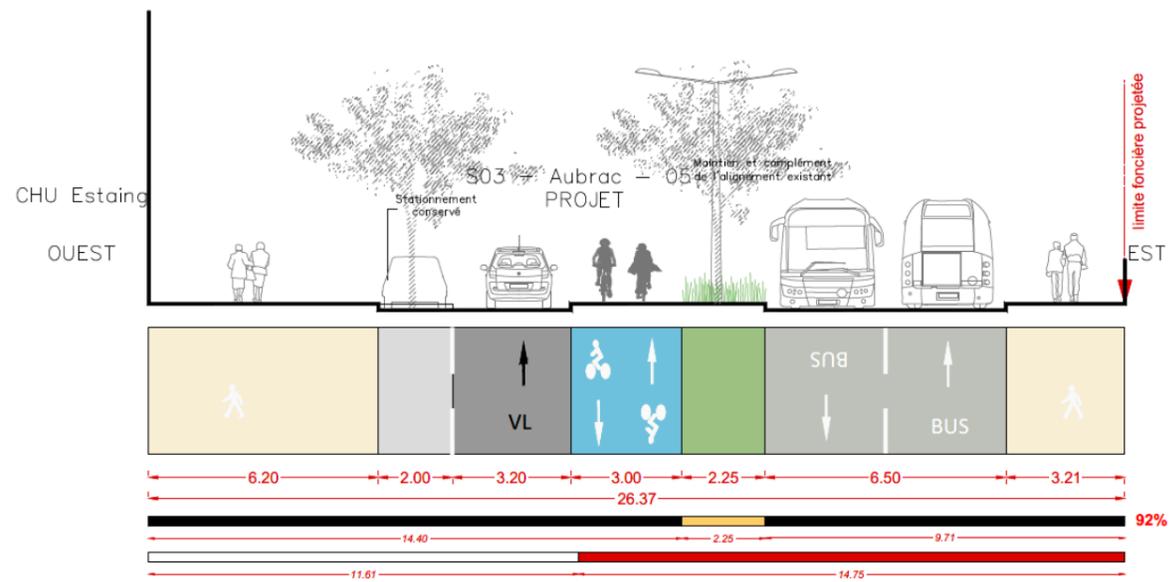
Profil d'insertion du projet de BHNS sur la rue Aubrac au droit du CHU Estaing
